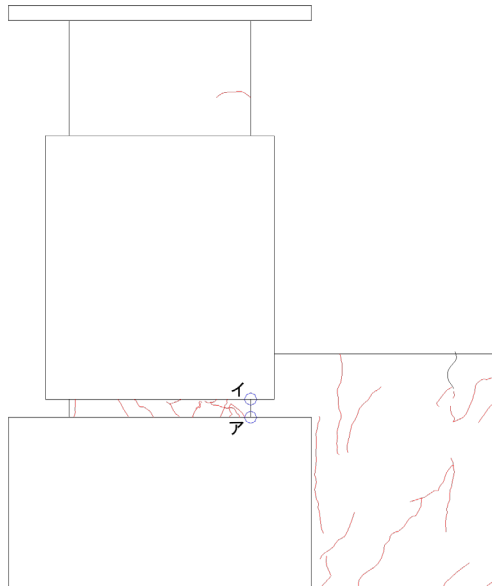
柱ひび割れ幅測定位置(試験体 A-1 負載荷)
